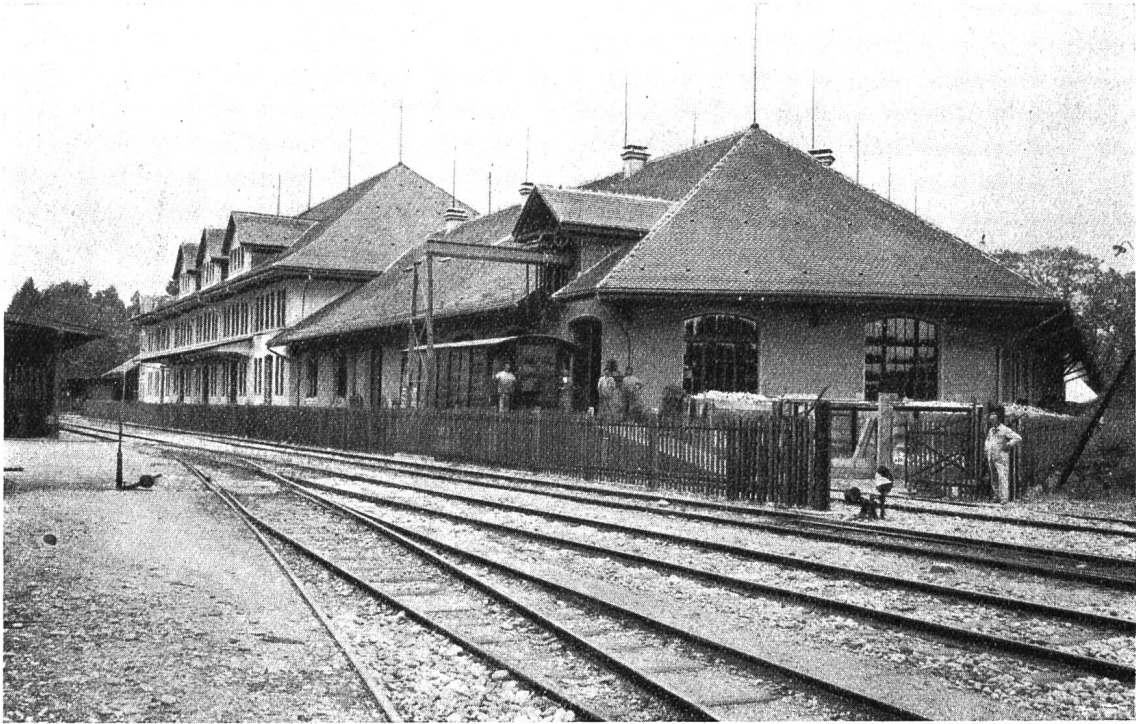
Eisen- und Kabelhalle (Nord- und Westfassade) und Hauptmagazin (Nordfassade).
